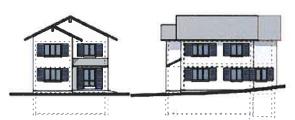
giebelseitiger, zweigeschossiger Anbau bei einem Einfamilienhaus mit ca. 38 m2 Erweiterungsfläche
